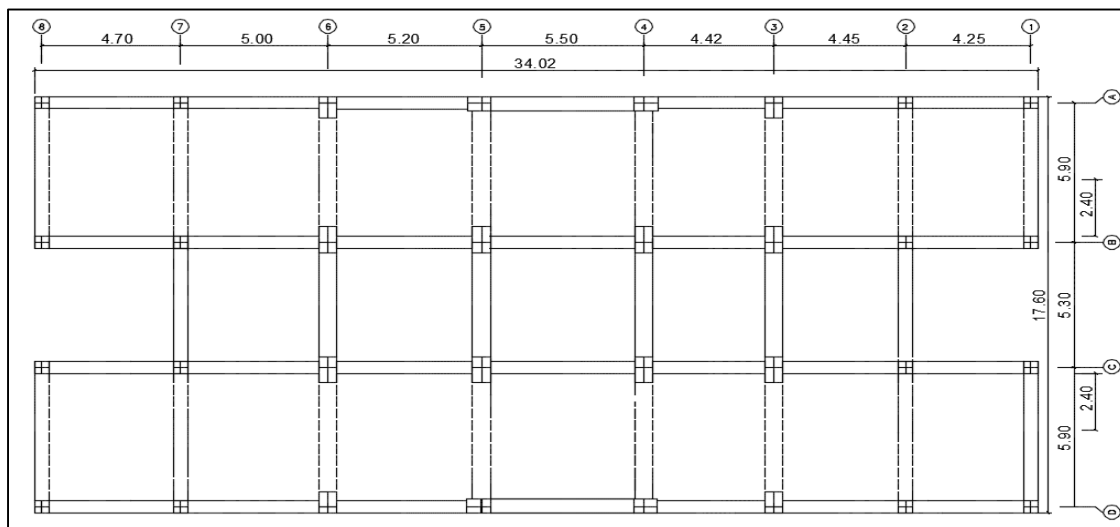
Esquema de vigas y orientación de las columnas de planta techo
